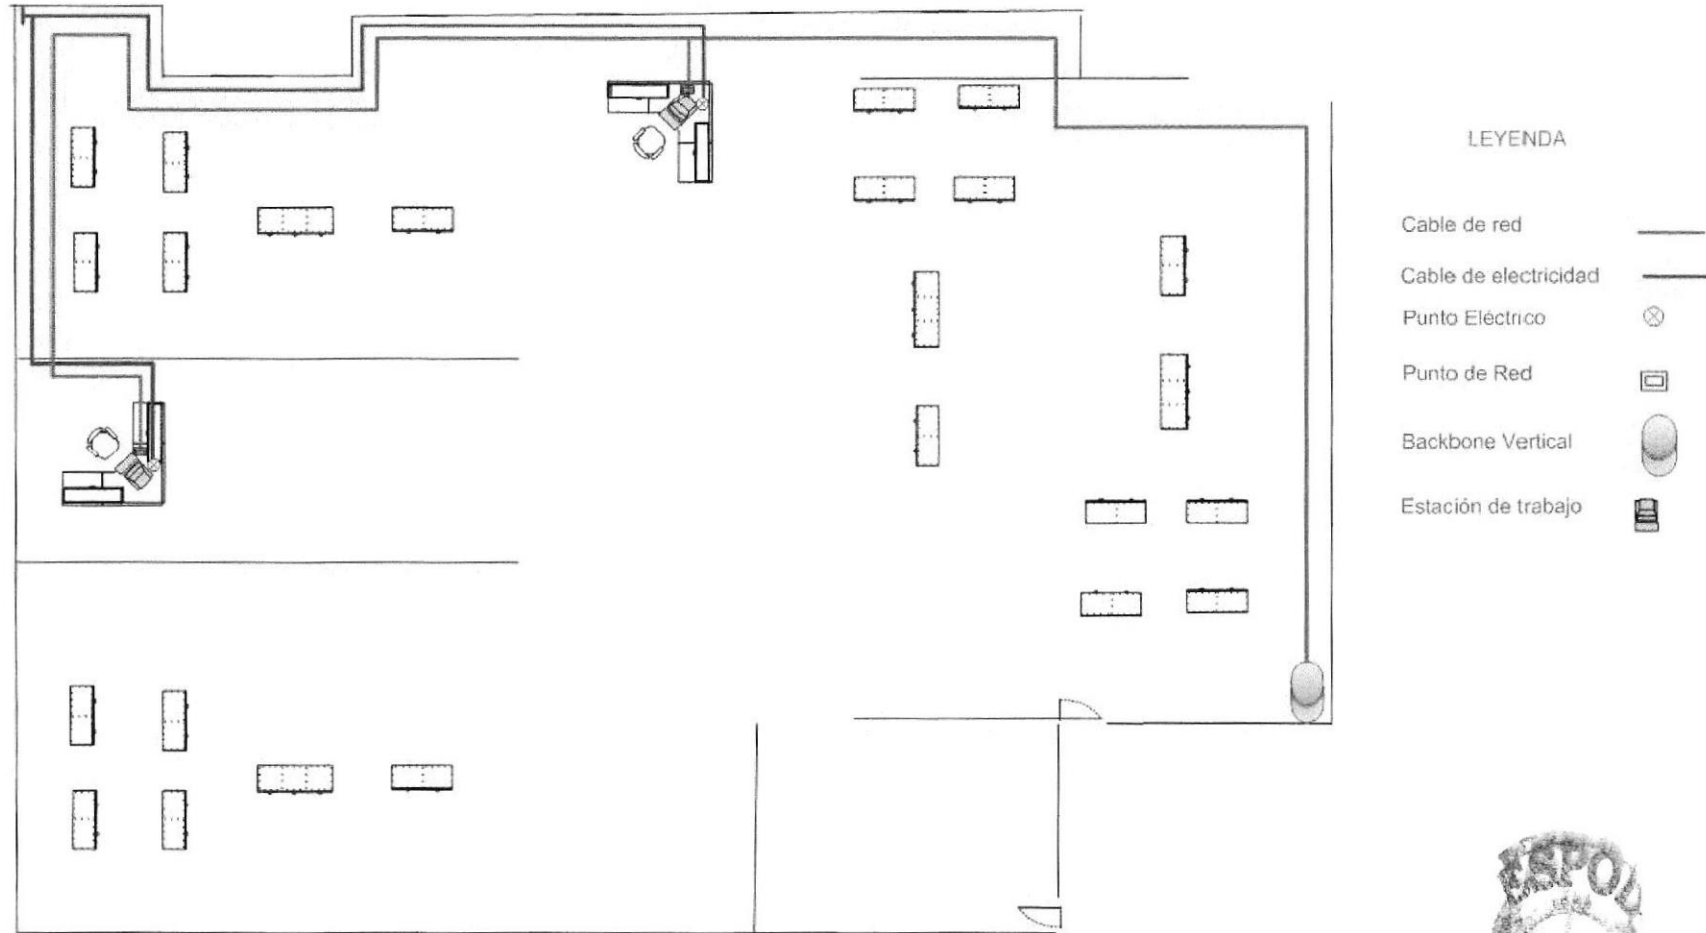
SEGUNDO PISO EDIFICIO SUCURSAL SUR
